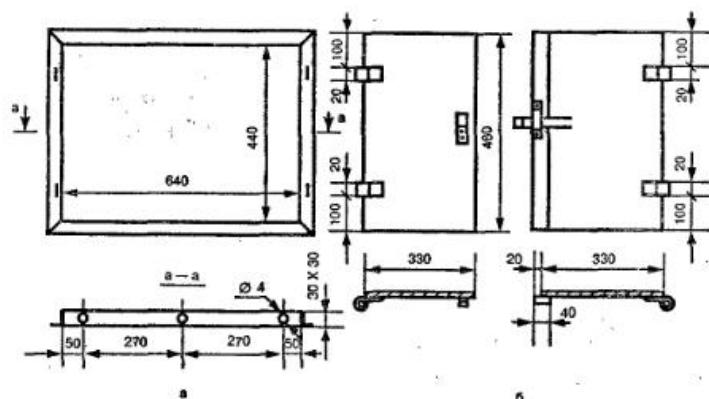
Дверца варочной камеры печи ИП-1. Размеры в мм
